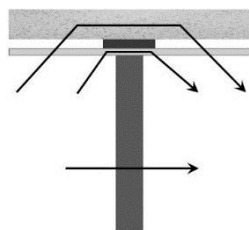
Execução de uma viga falsa ou de uma ligação flexível entre o teto e a parede
